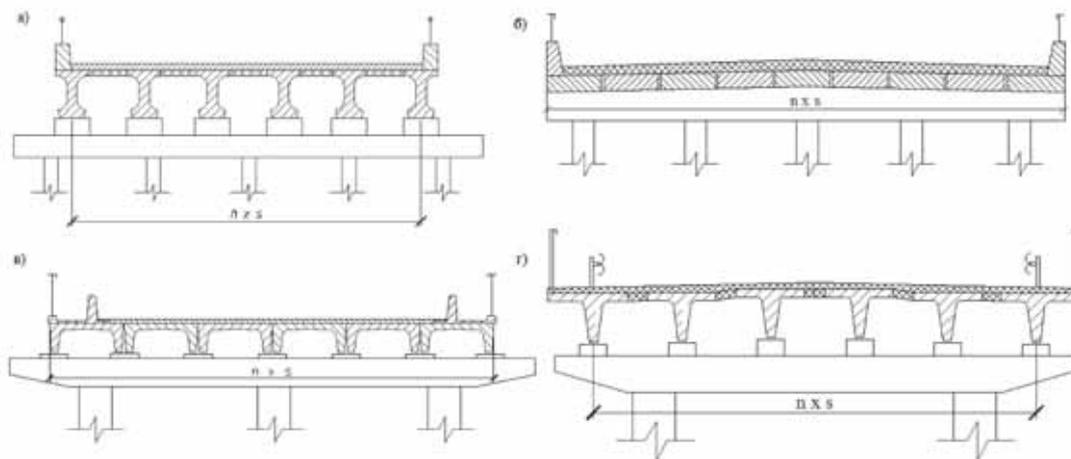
Типы железобетонных пролетных строений на дорогах регионального и федерального значения Республики Саха (Якутия): а – преднапряженное железобетонное пролетное строение с двутавровым сечением; б – плитное пролетное строение; в – железобетонные сводчатые плиты; г – железобетонные пролетные строения с тавровым сечением без диафрагм
